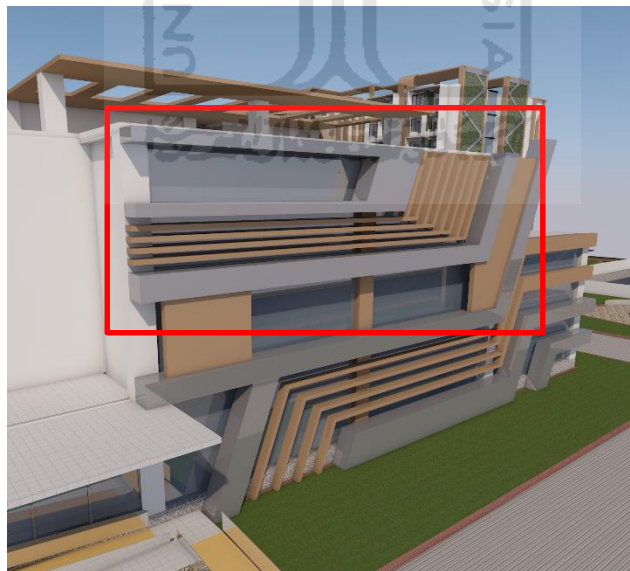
Penerapan External Shading pada Fasad Apartment
